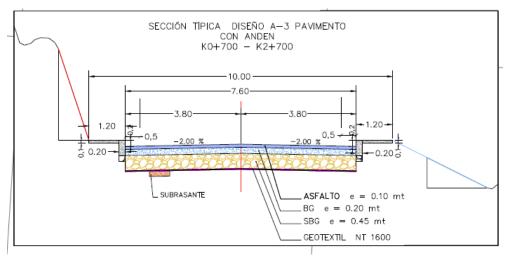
Estructura del pavimento sección k0+700 a 2+800
